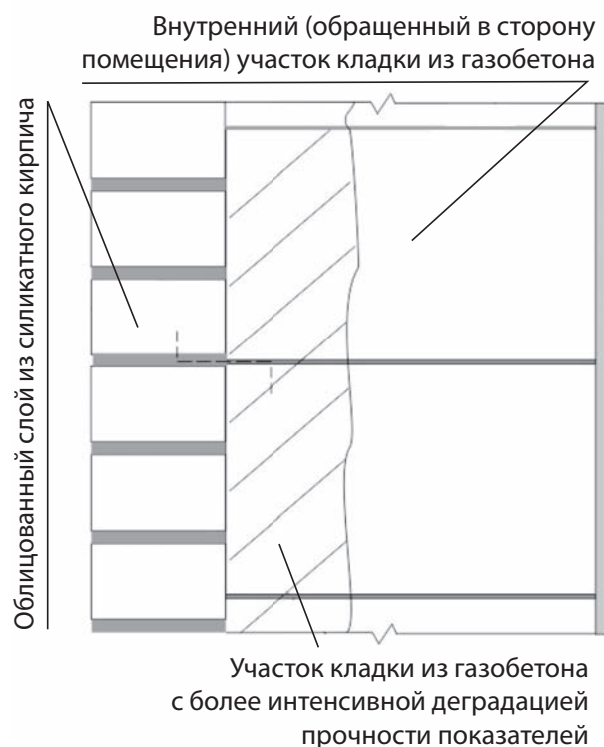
Схема разрушения испытываемой стеновой конструкции
